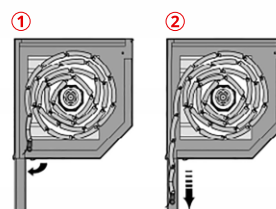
i 18 - Montaż wieszaków blokady na wale 70.
